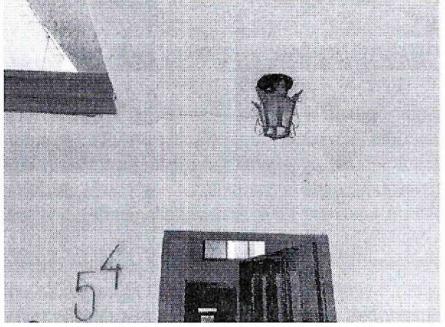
Fisura en alero de entrada, junta entre elementos.
